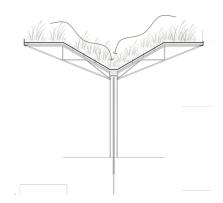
Corte constructivo de las cubiertas de los andenes del transporte público.
